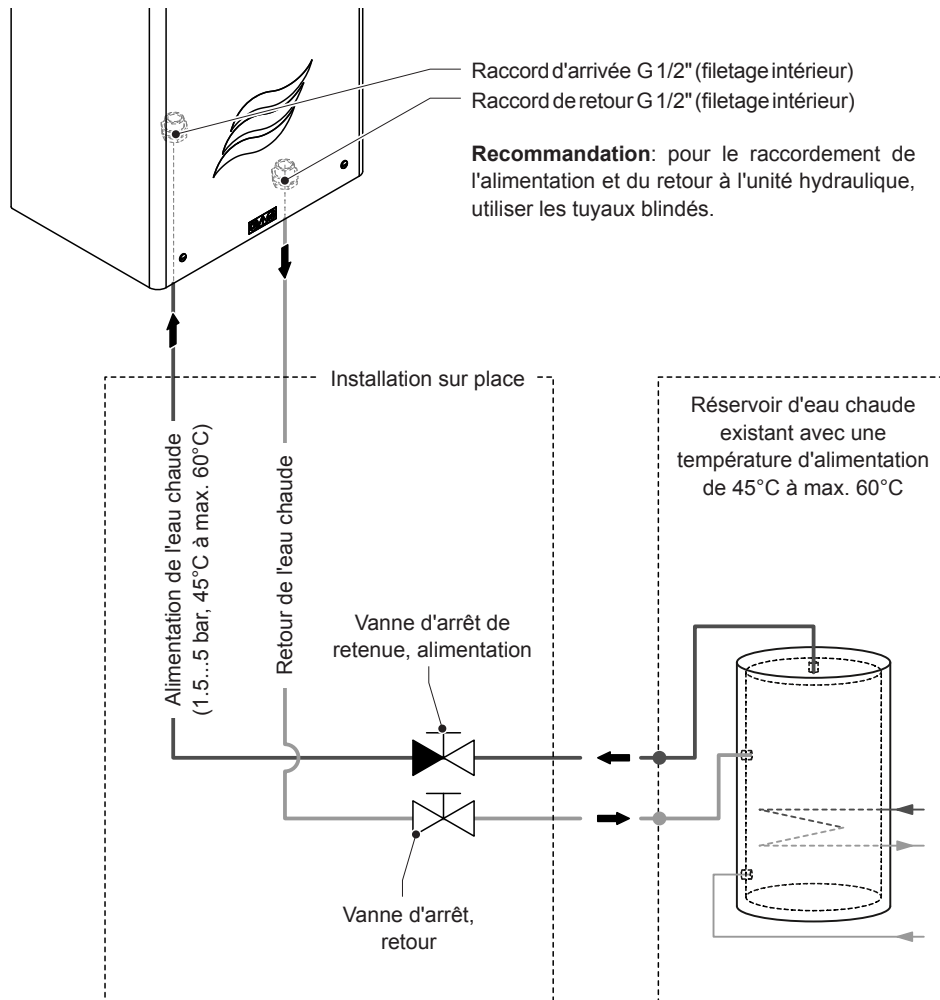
Aperçu de l'installation du raccord d'eau chaude pour la variante WW
